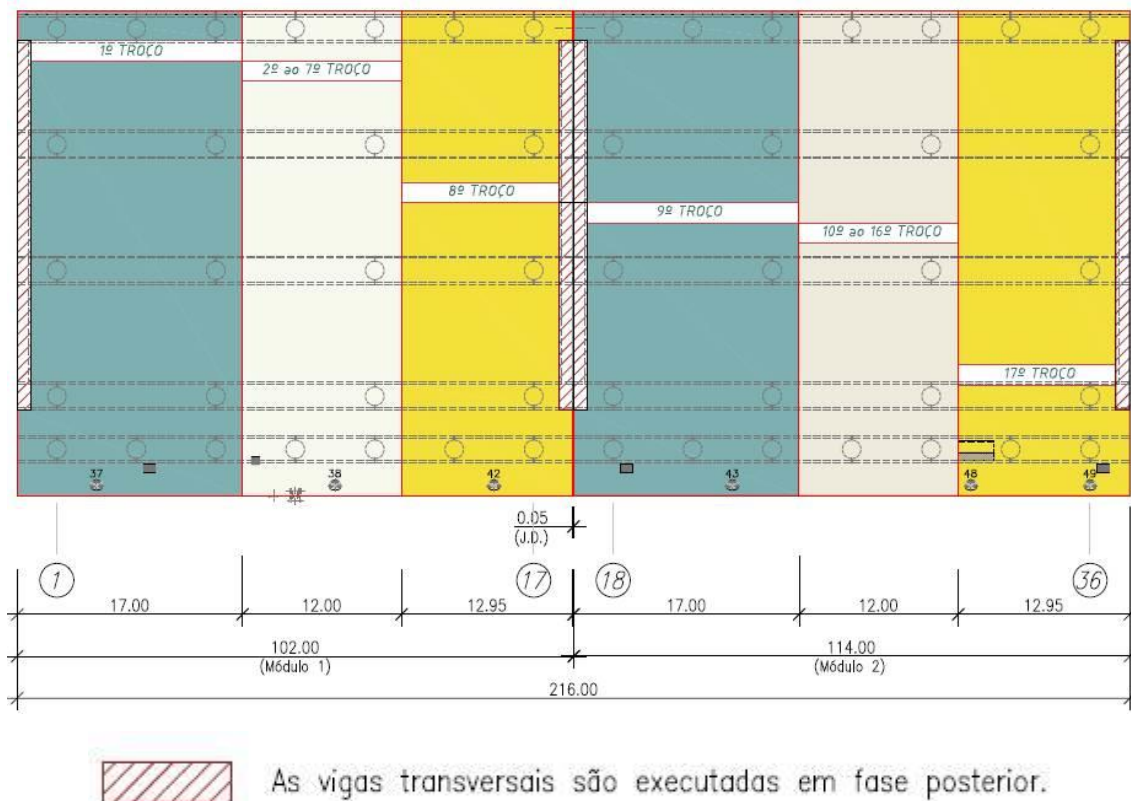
Betonagem do tabuleiro: Plano longitudinal de betonagem
